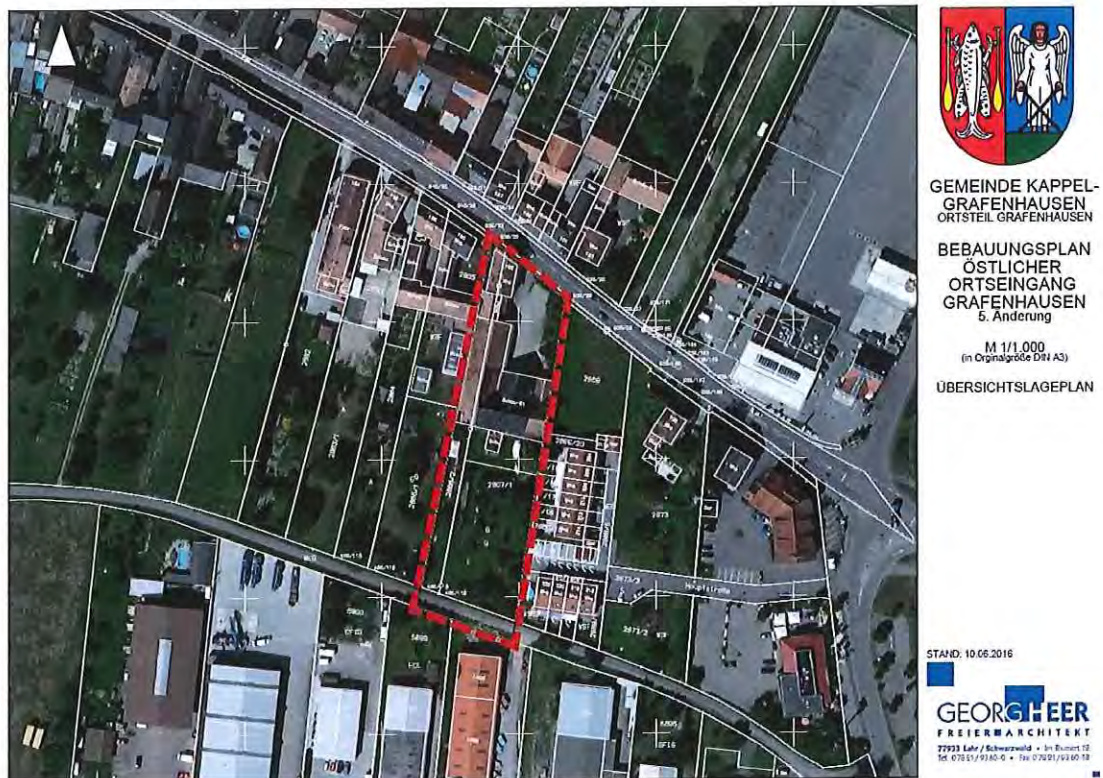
Bebauungsplan (Quelle: Architekturbüro Heer, Lahr)
